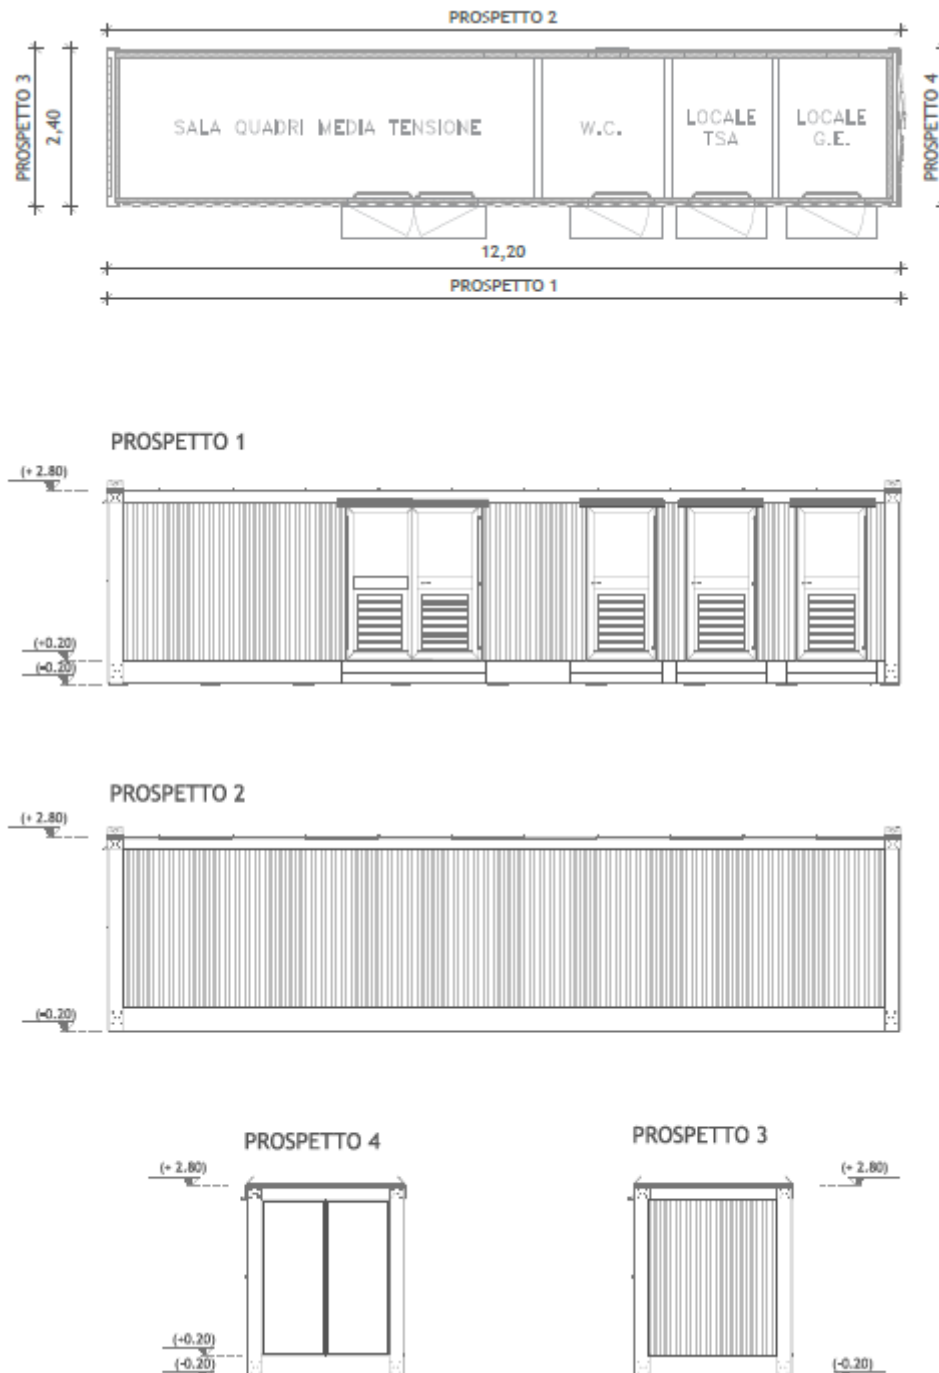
Planimetria e prospetti dell'Edificio Quadri
